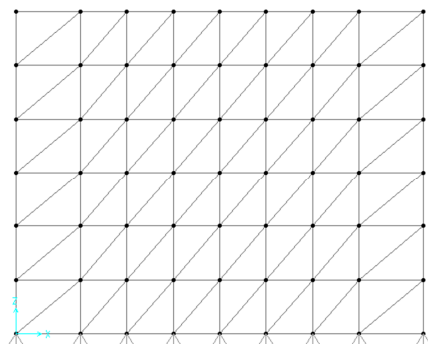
Configuração dos Planos de Contraventamento Vertical Com Elementos de Contraventamento Pequenos
